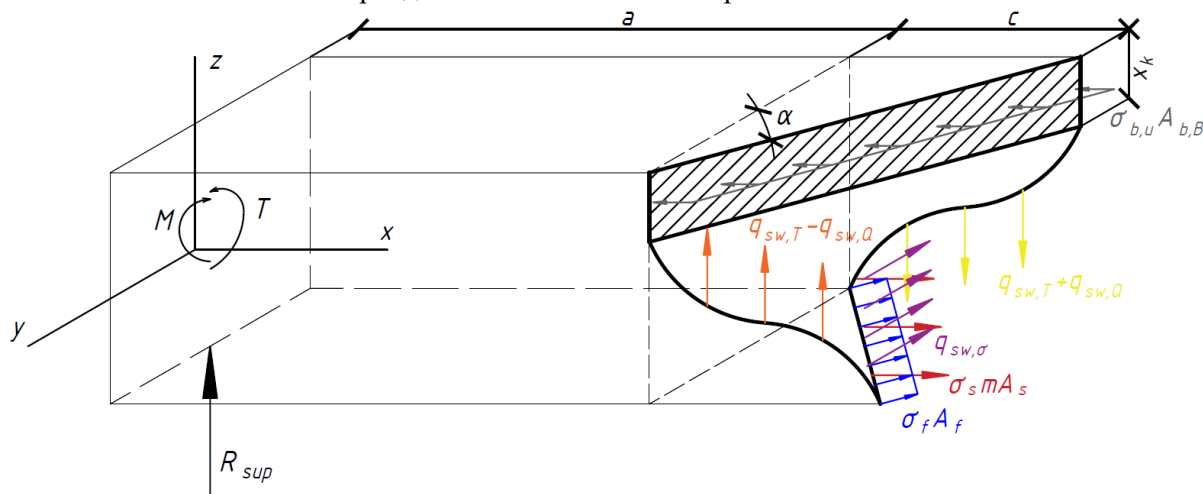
Предполагаемые усилия в пространственном сечении в железобетонном элементе с внешним композитным армированием при изгибе с кручением, для схемы I расположения сжатой зоны
